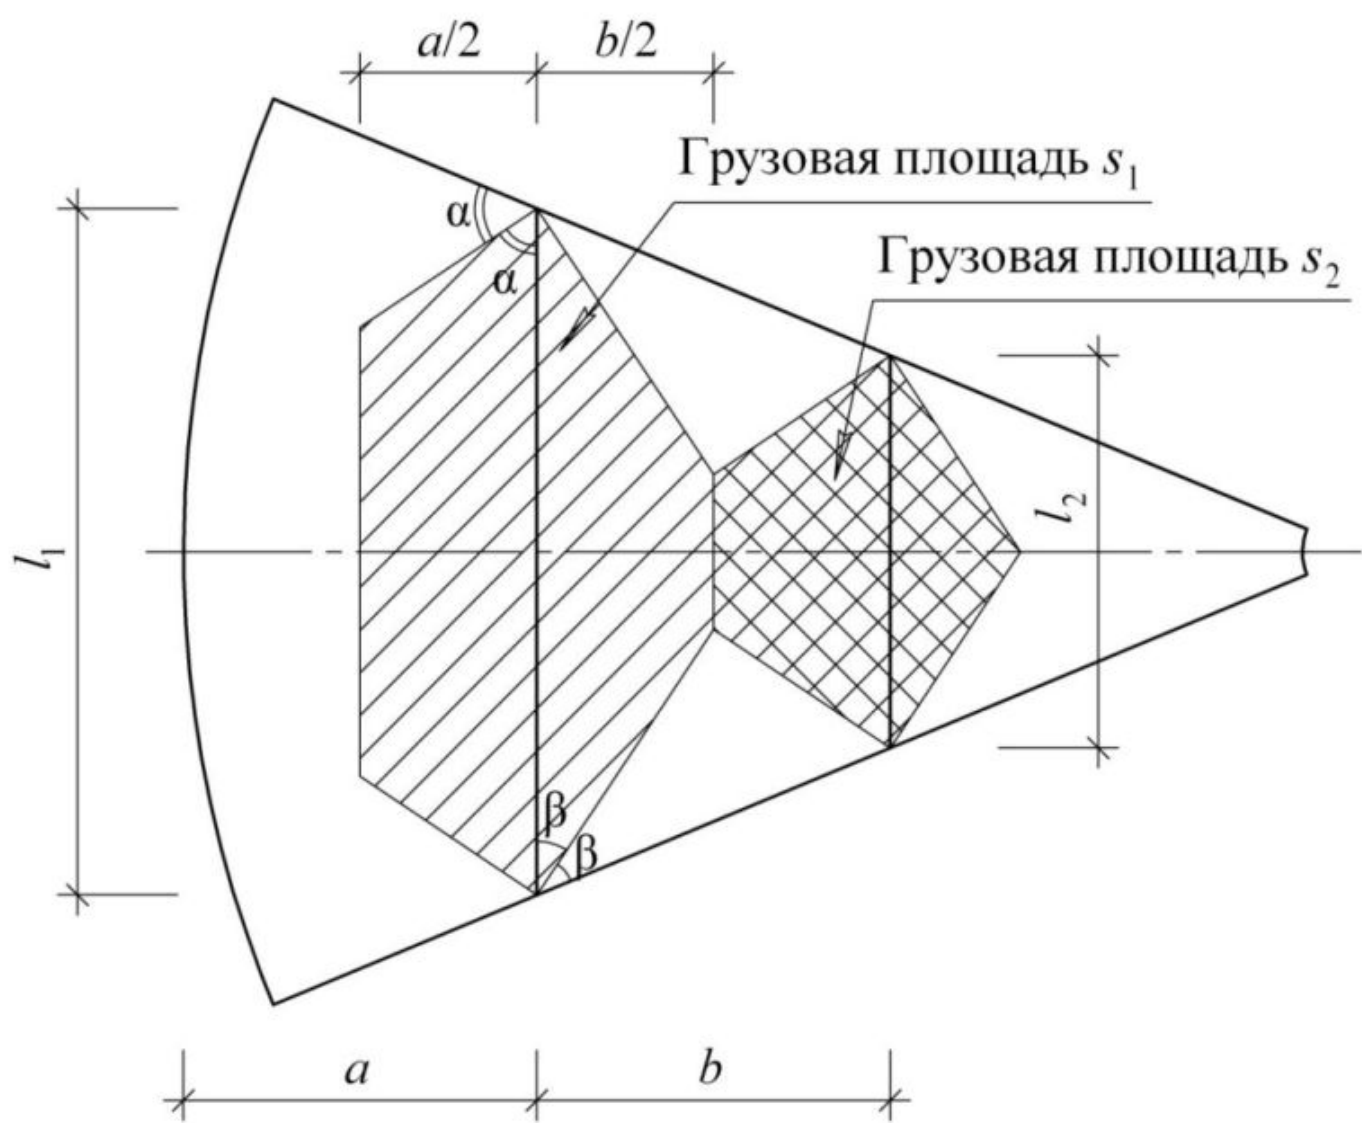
Определение грузовых площадей для поперечных рёбер
